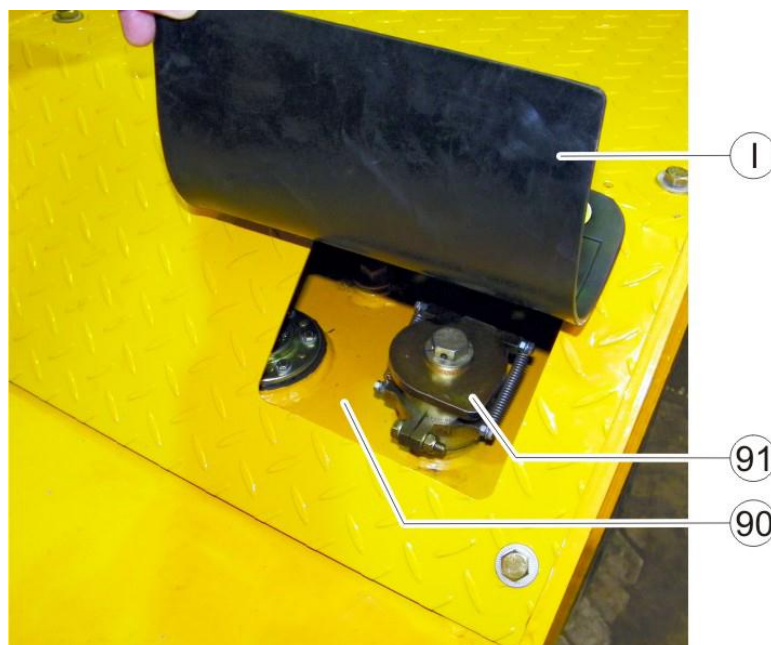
Estanque y tubo de llenado de combustible Diesel
